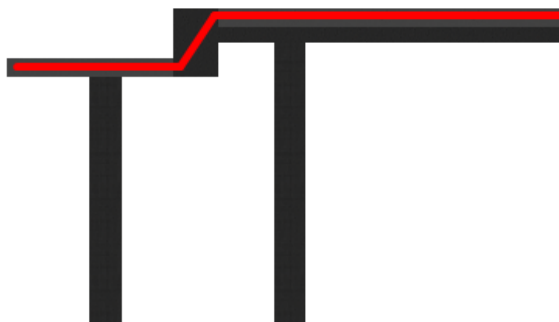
Modelo estrutural em corte demonstrando passagem da armadura principal da solução.
